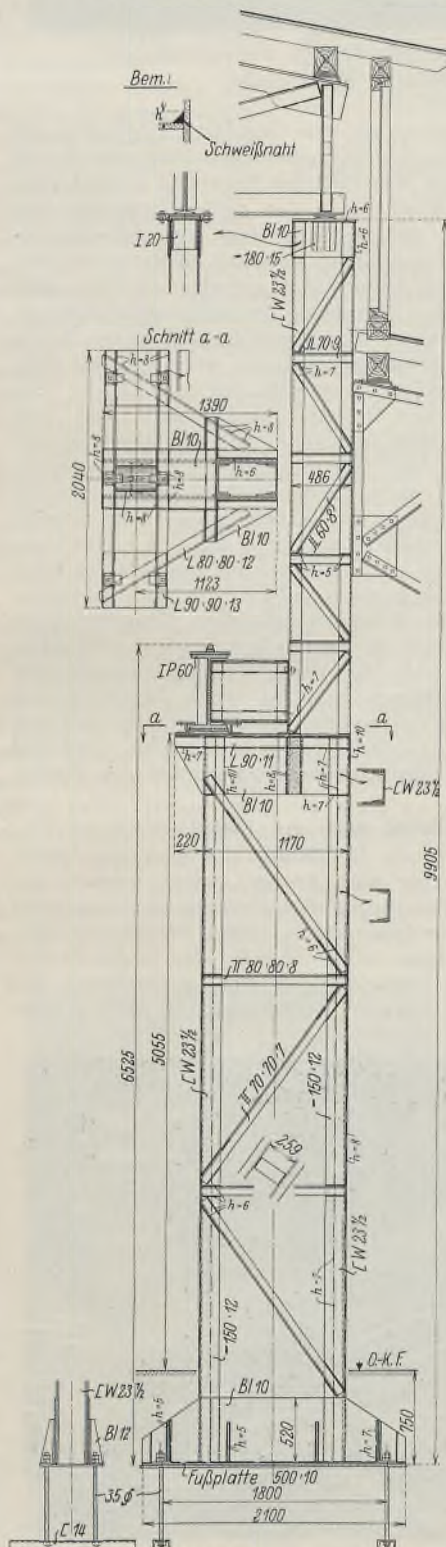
Geschweißte Stütze einer Werkstatthalle.
